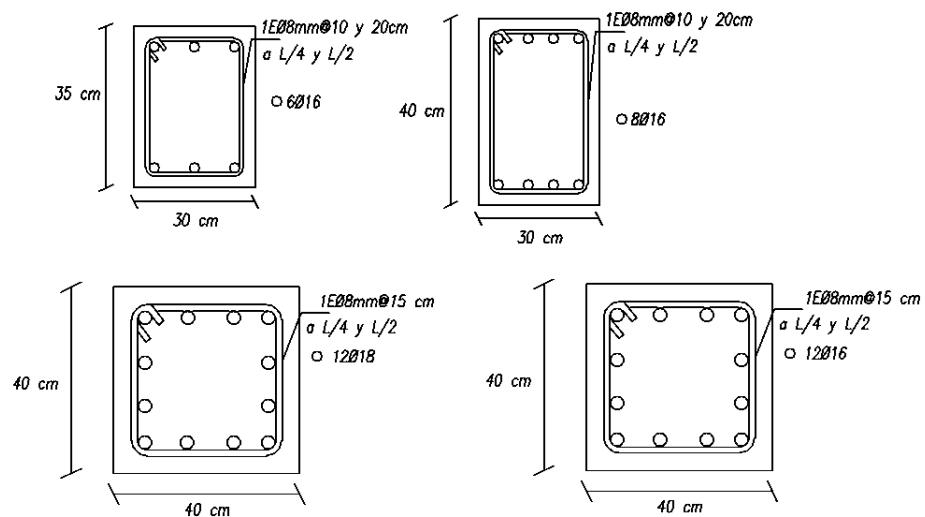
Dimensiones mínimas ACI para vigas y columnas necesarias para las luces propuestas con menor número de estribos.
